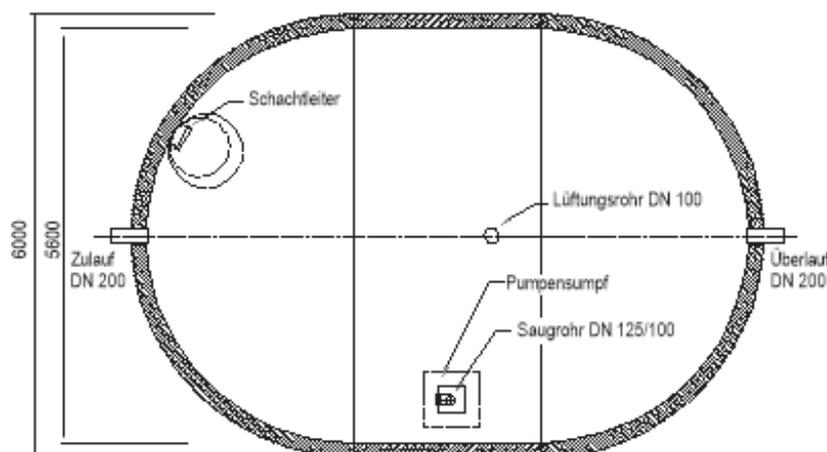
Grundriss Zisterne (z.B. Mall-Löschwasserbehälter, LW 100)
